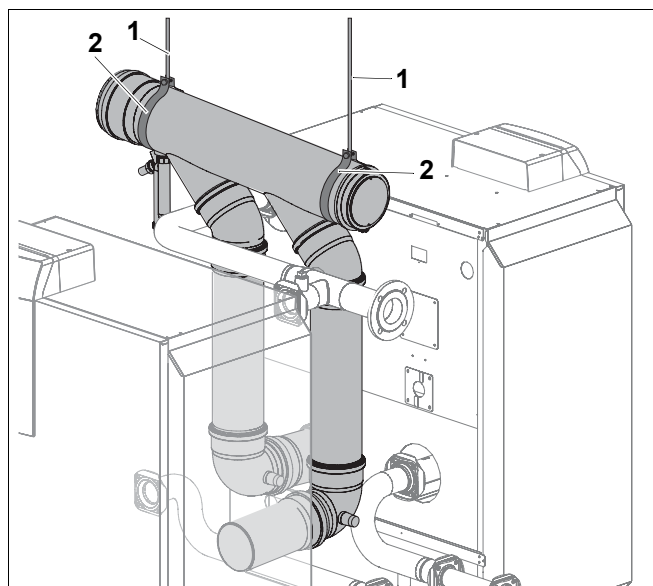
Пример крепления коллектора дымовых газов на установке с двумя котлами 400, 480 или 560 кВт
